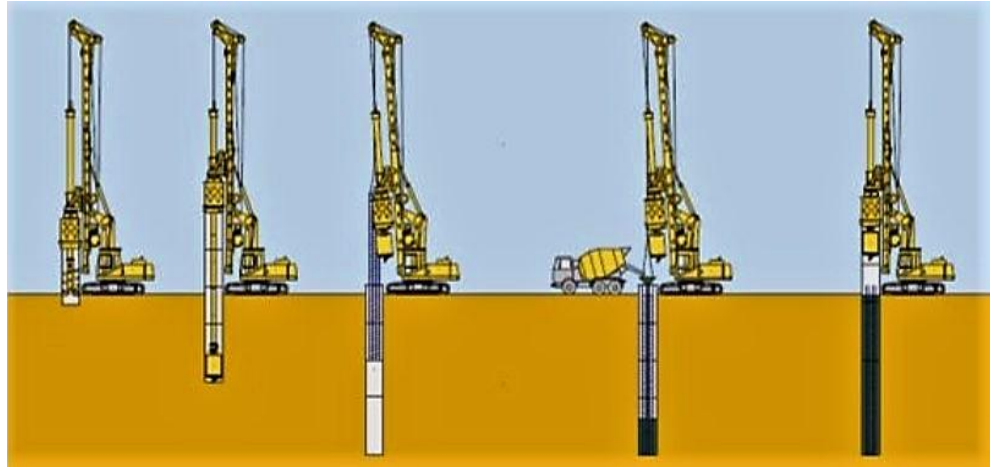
Esquema sobre colado de pilote con ademado metálico.
